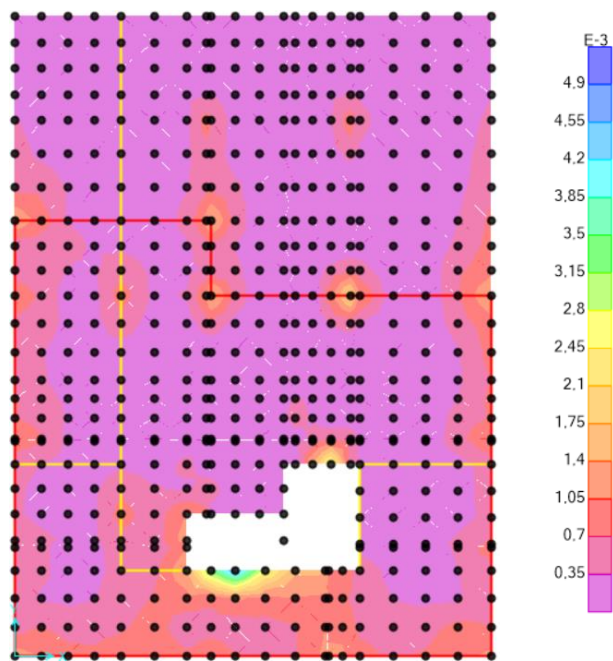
Área de armadura inferior na laje do piso 0 segundo a direção y em m2/m
